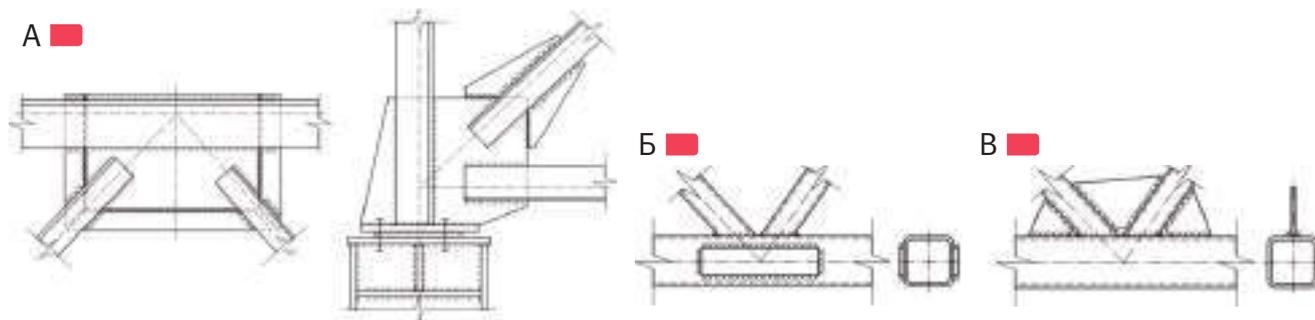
А – усиление узлов крепления стержней ферм из парных уголков; Б – усиление узлов крепления стержней ферм из гнутосварных замкнутых профилей
